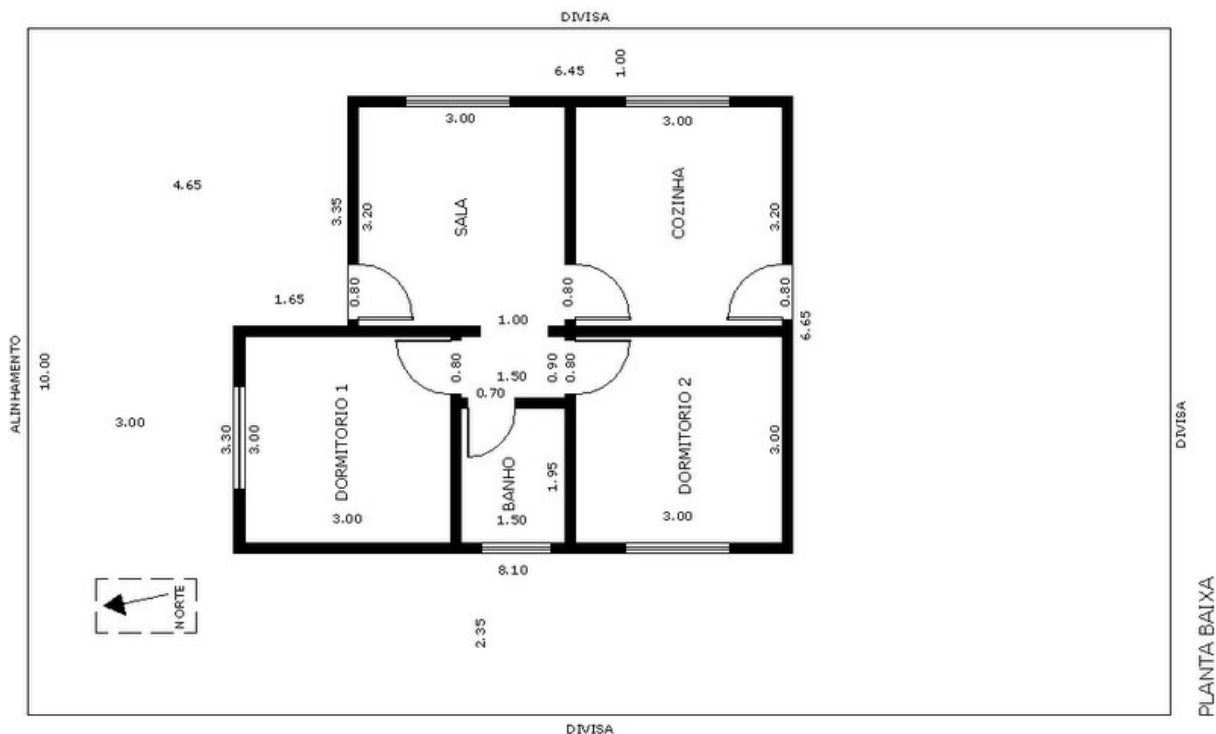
Planta Baixa da casa 2 (casa com evidencia de bolor)
